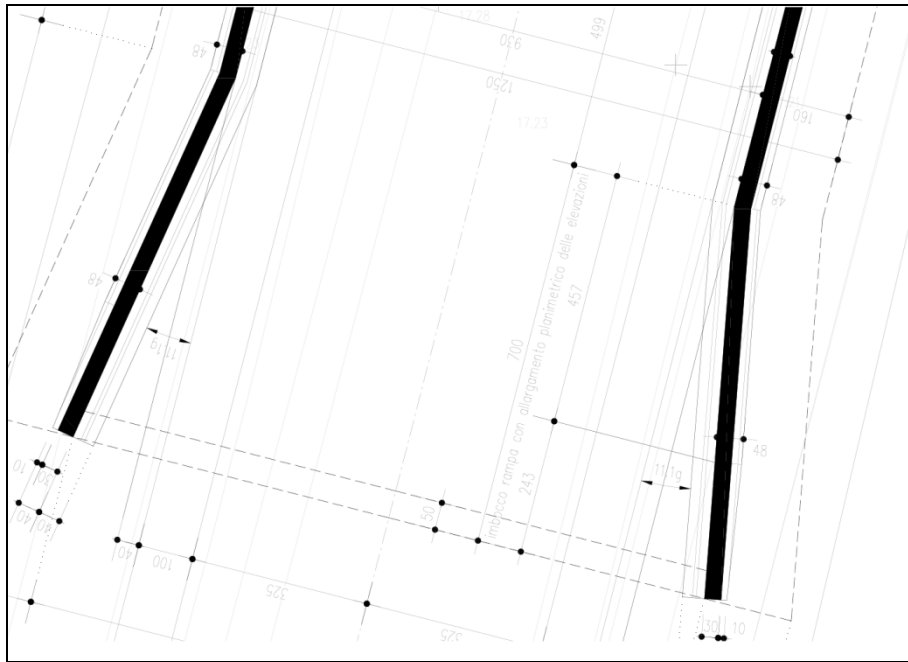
PARTICOLARE ALLARGAMENTO PLANIMETRICO DELLE ELEVAZIONI
